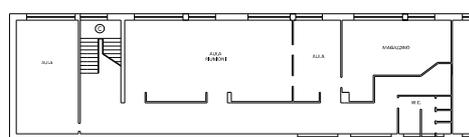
7: Pianta piano terzo seminterrato (blocco aule 2).
